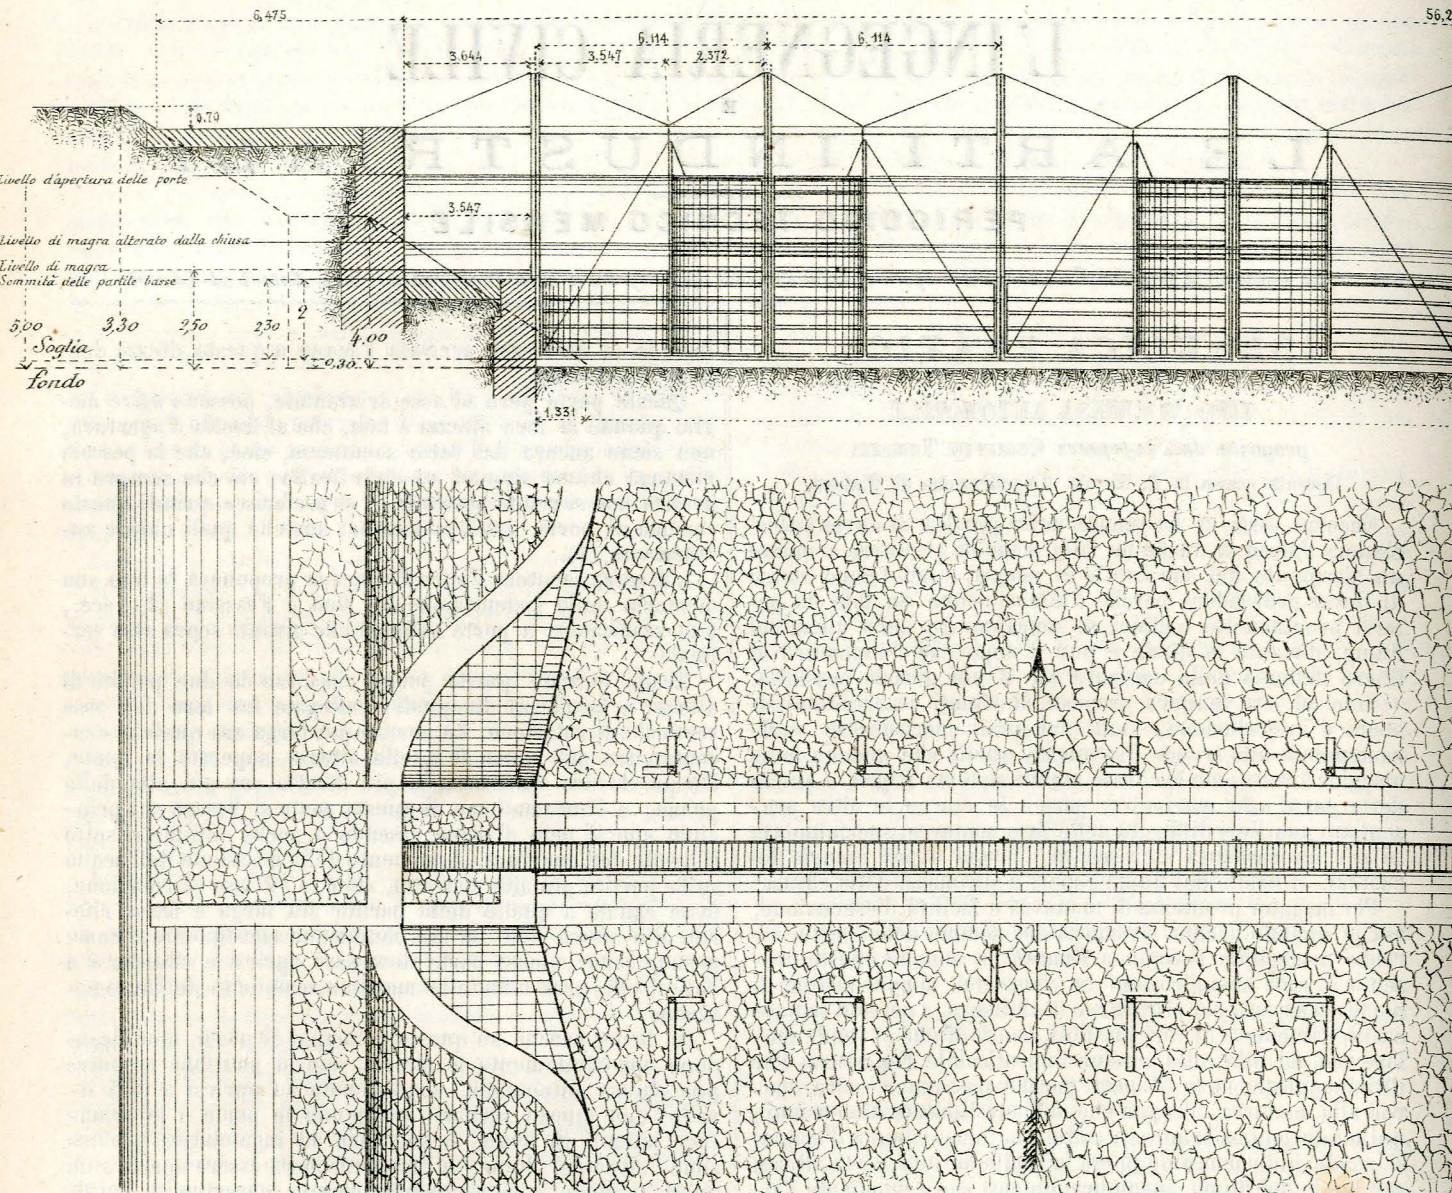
e 39. — Elevazione e pianta di metà della chiusa.
